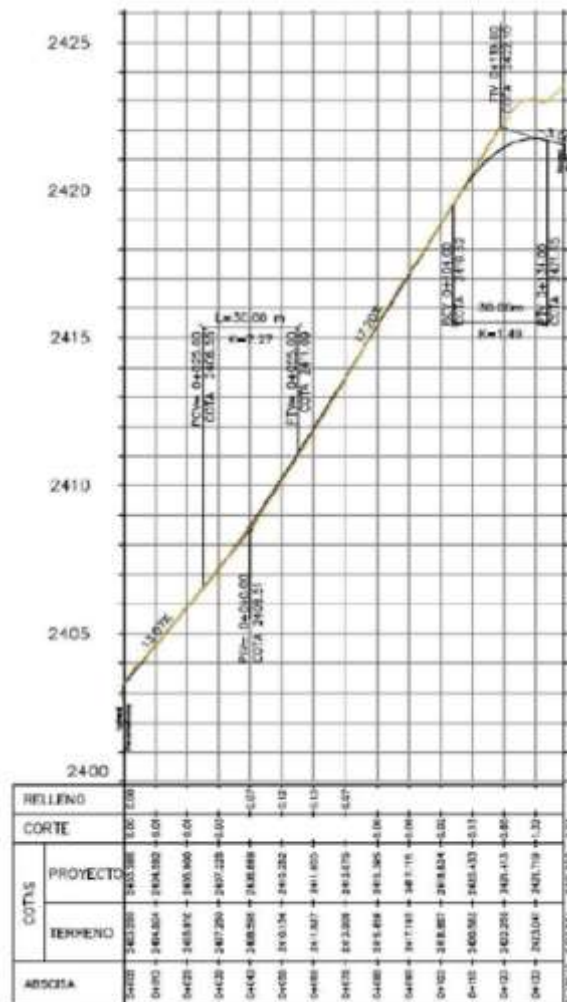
Perfil vertical del diseño existente de la vía de acceso; Fuente: Equipo consultor arquitectónico
